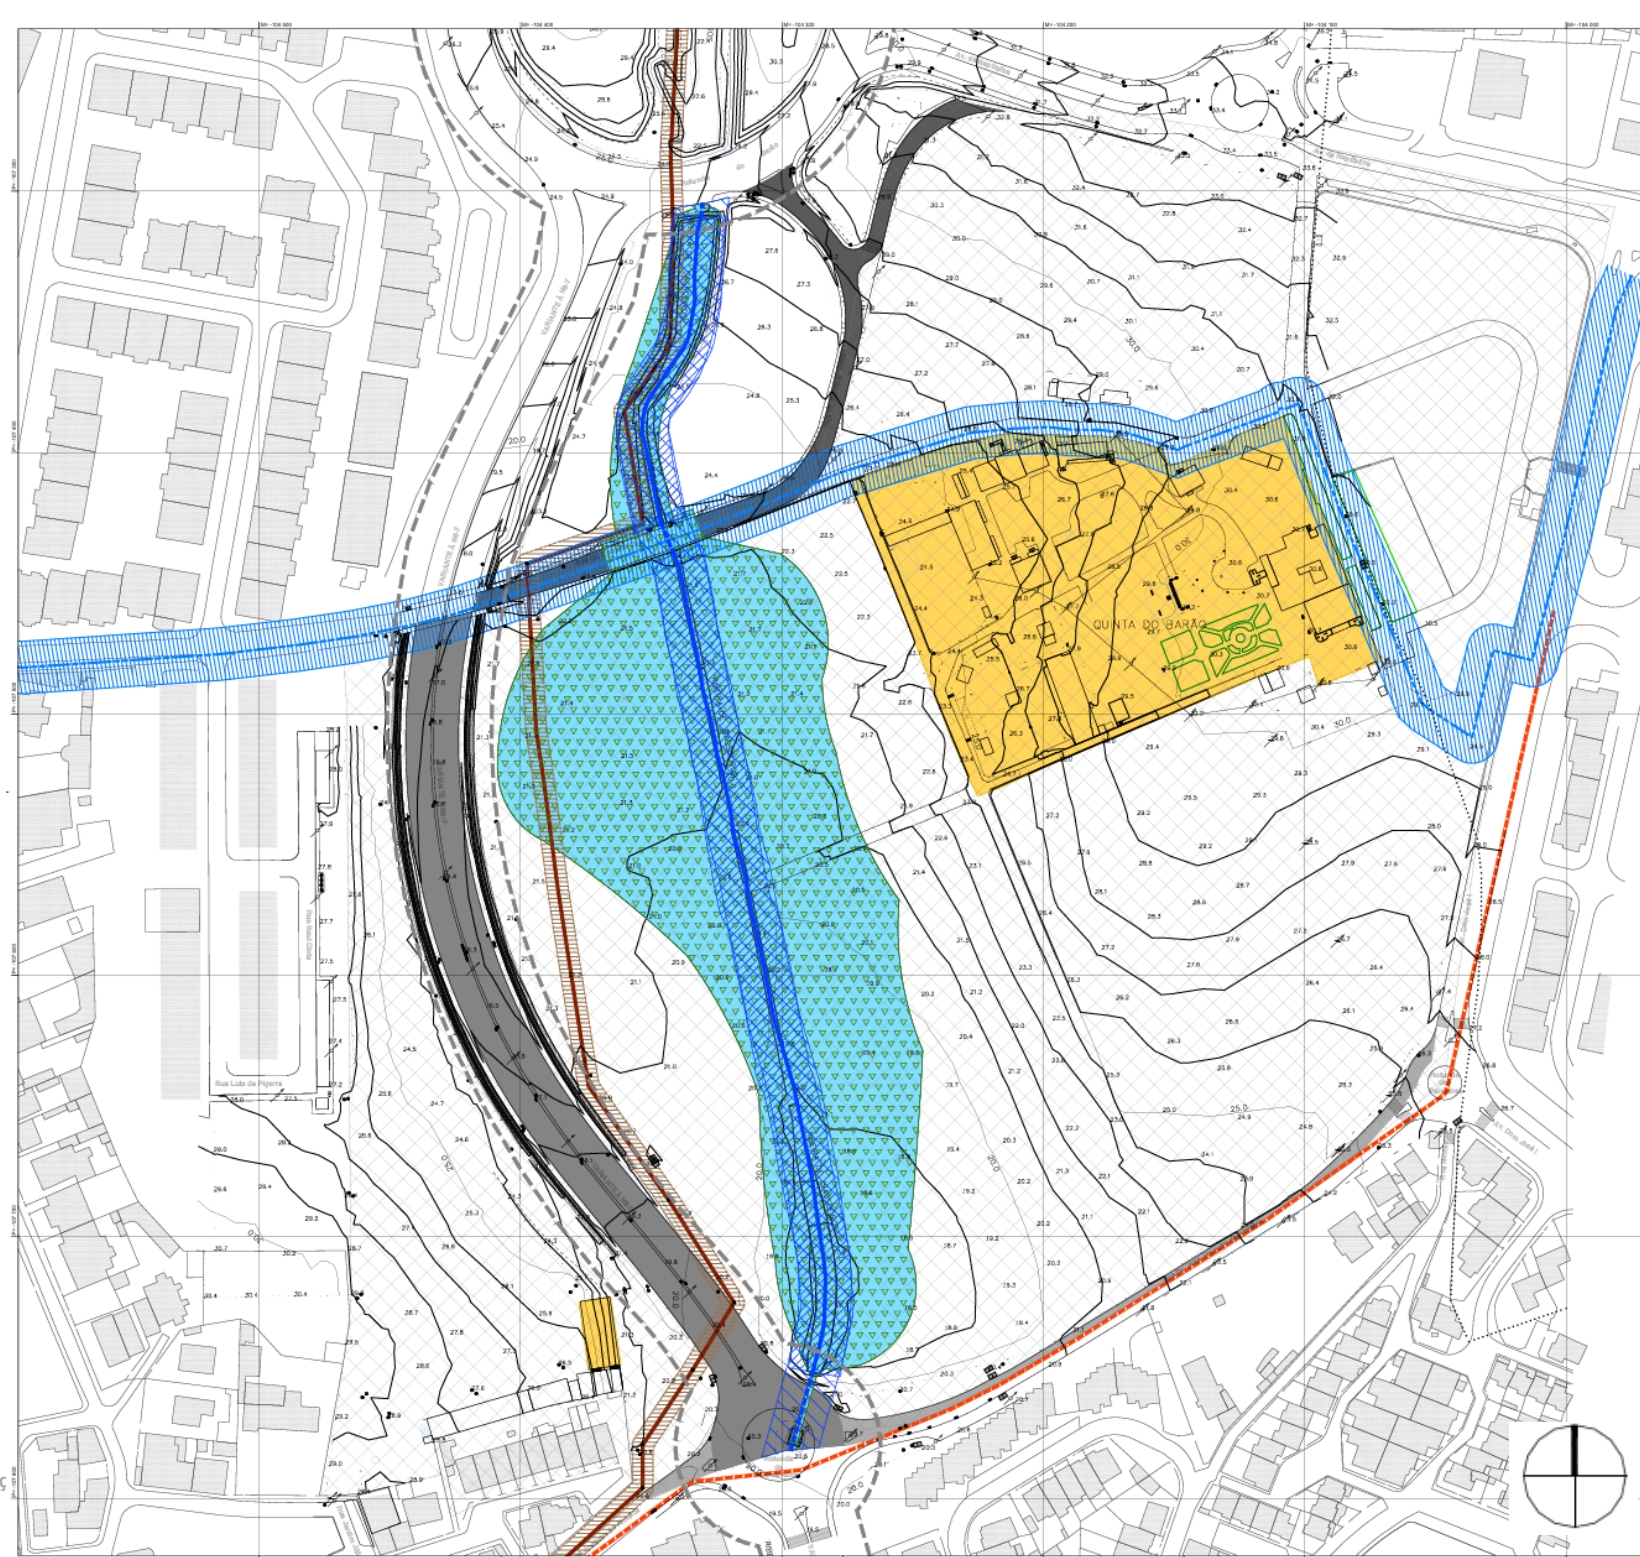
Planta de condicionantes – infraestruturas do PDM de Cascais em Vigor (PDM Cascais, 2015)
